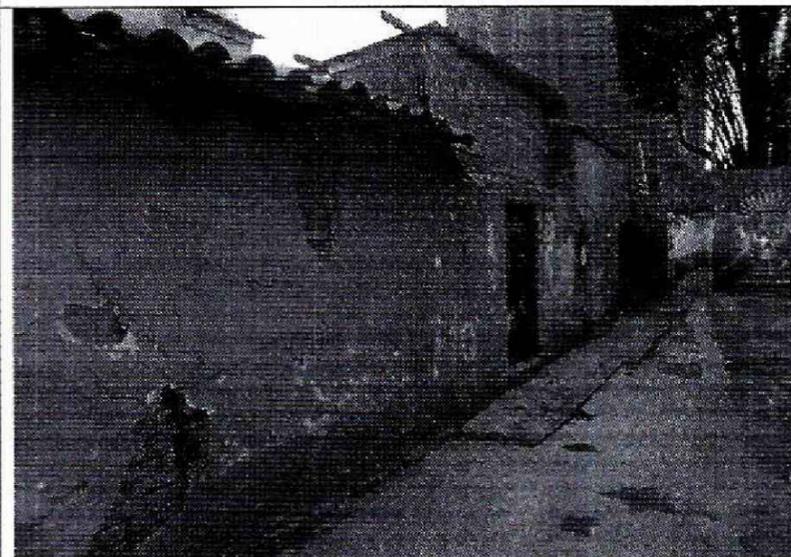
Fisuras y desprendimientos de acabados en el muro de fachada del costado oriental.
